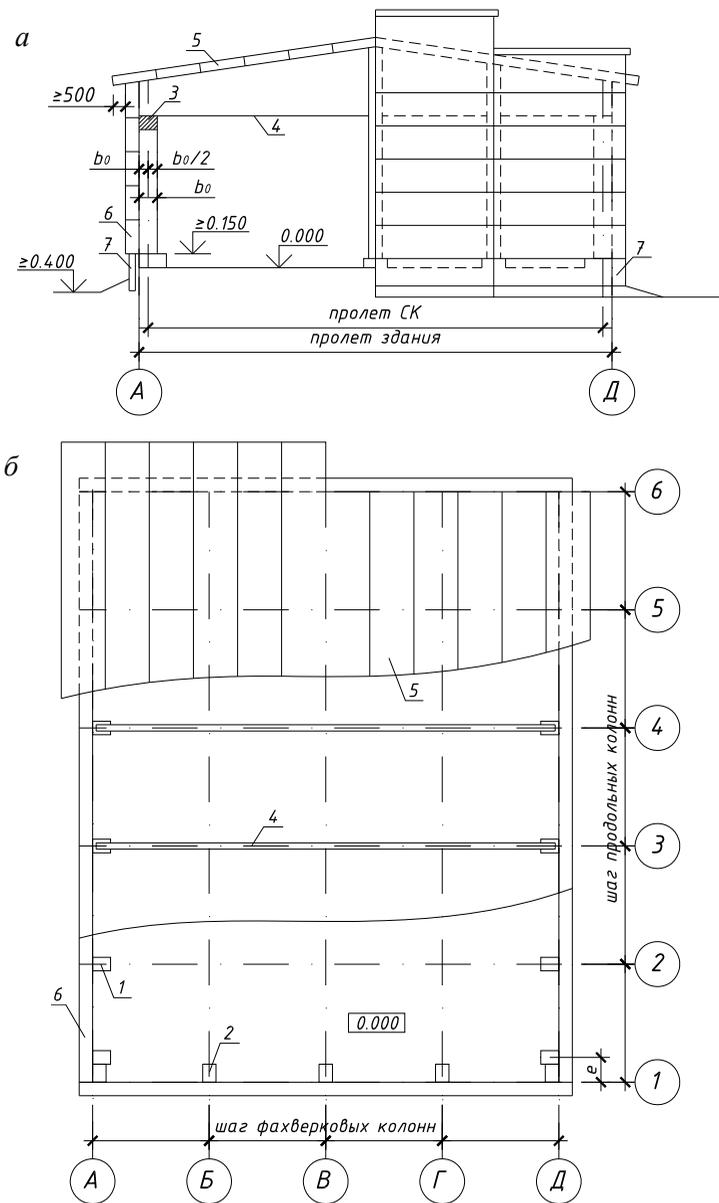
Фрагменты деревянного одноэтажного однопролетного бескранового здания со сплошными колоннами (привязка нулевая)
